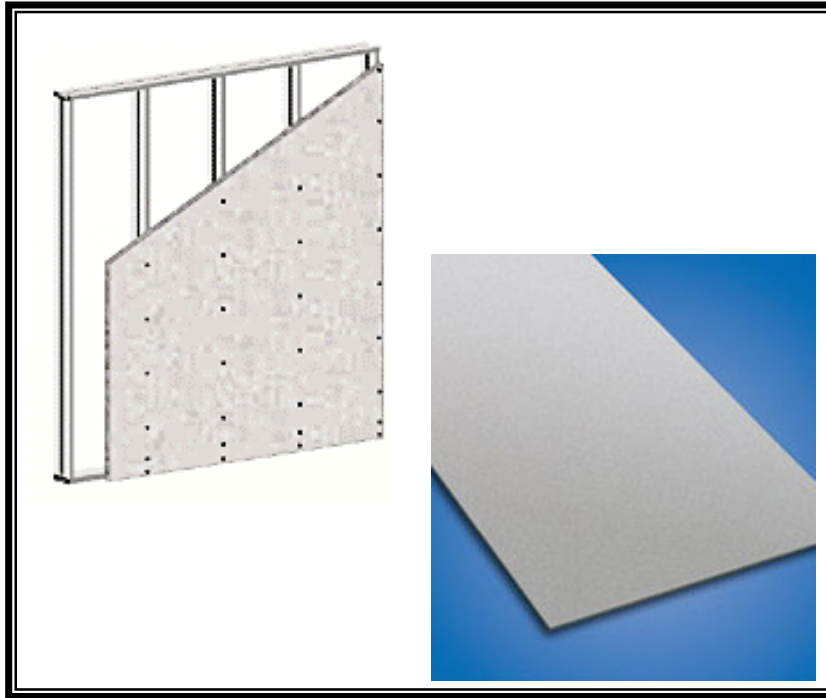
Parede de Placa Cimentícia e detalhe. Fonte: BRASILIT, 2005
